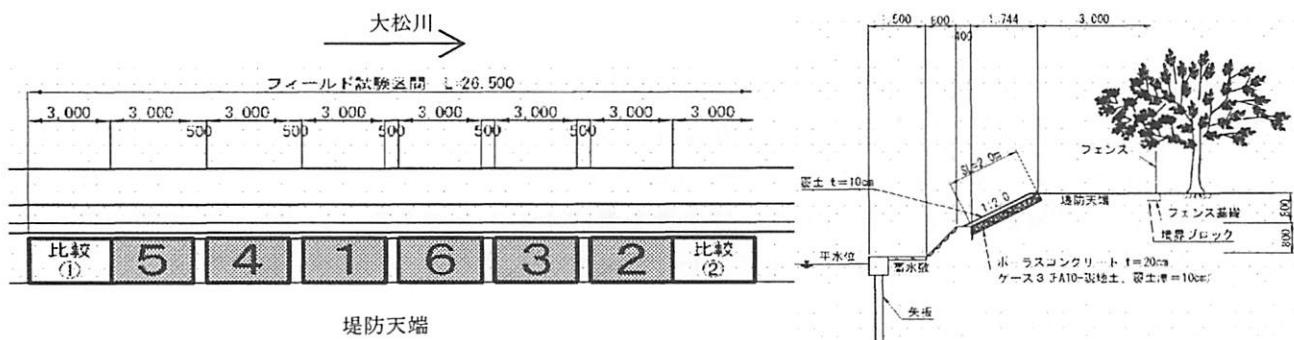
フィールド試験計画図(左図: ケース配置平面図, 右図: 標準断面図)
